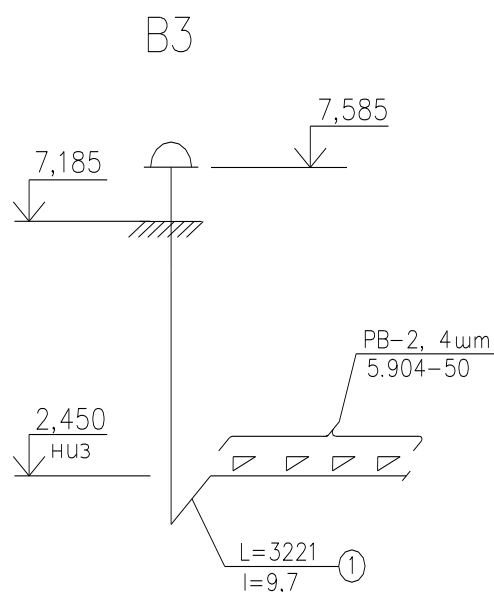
Расчетная схема механической вытяжной системы вентиляции В3
